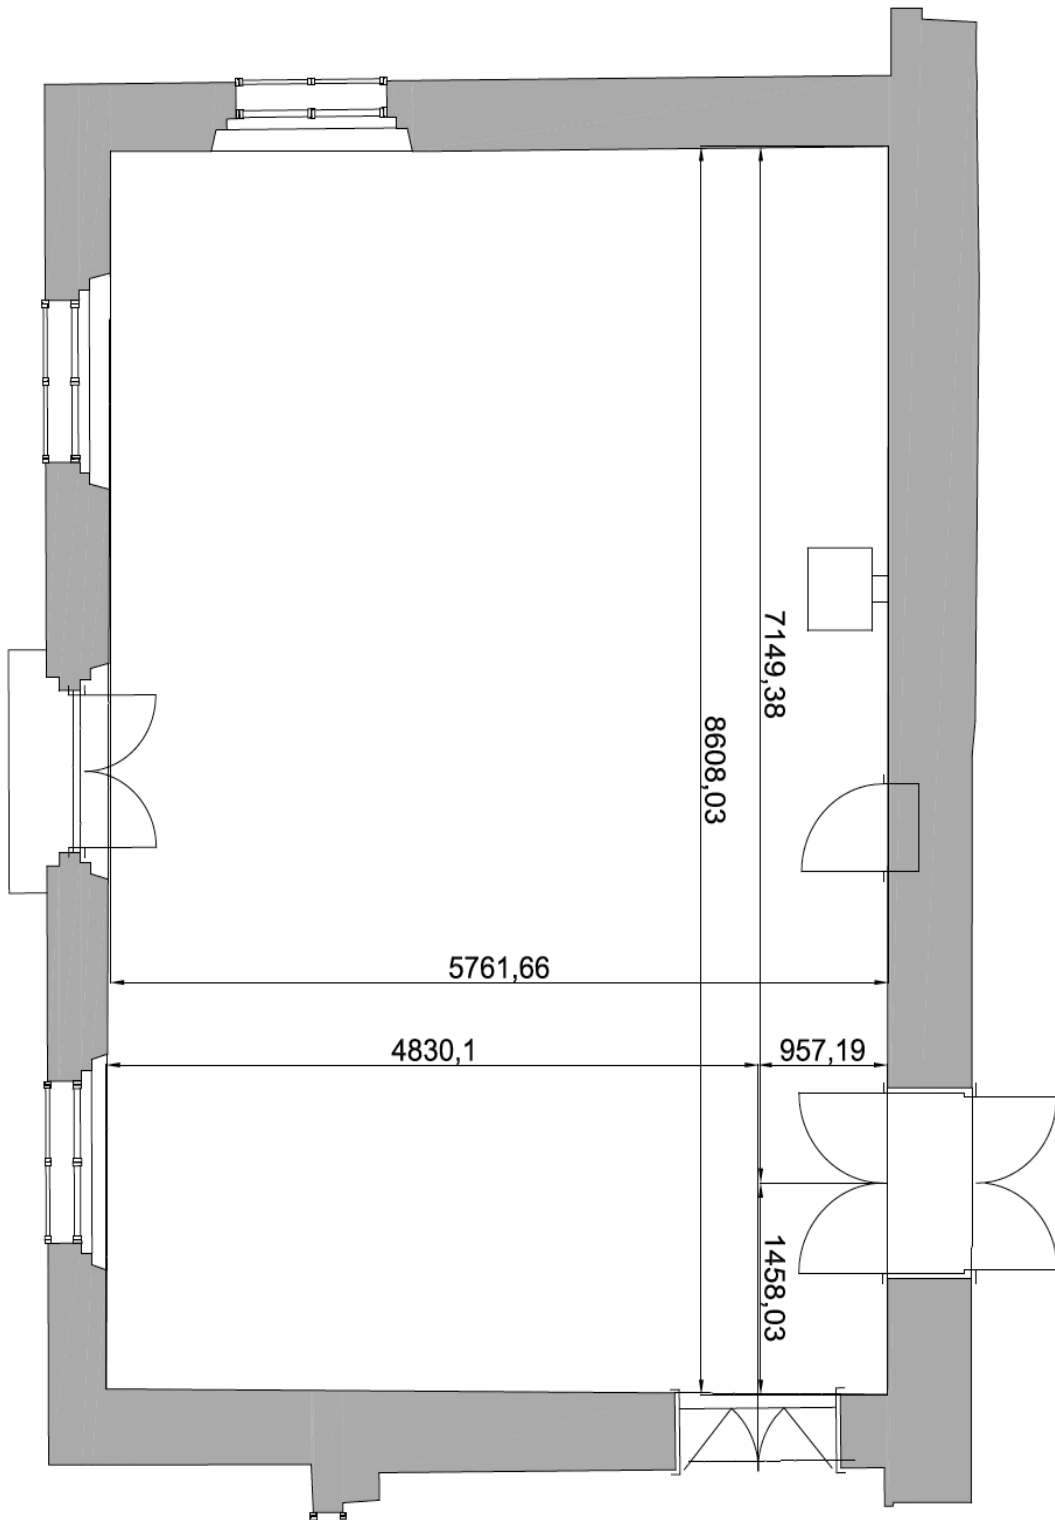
Grundriss vom Besprechungszimmer
